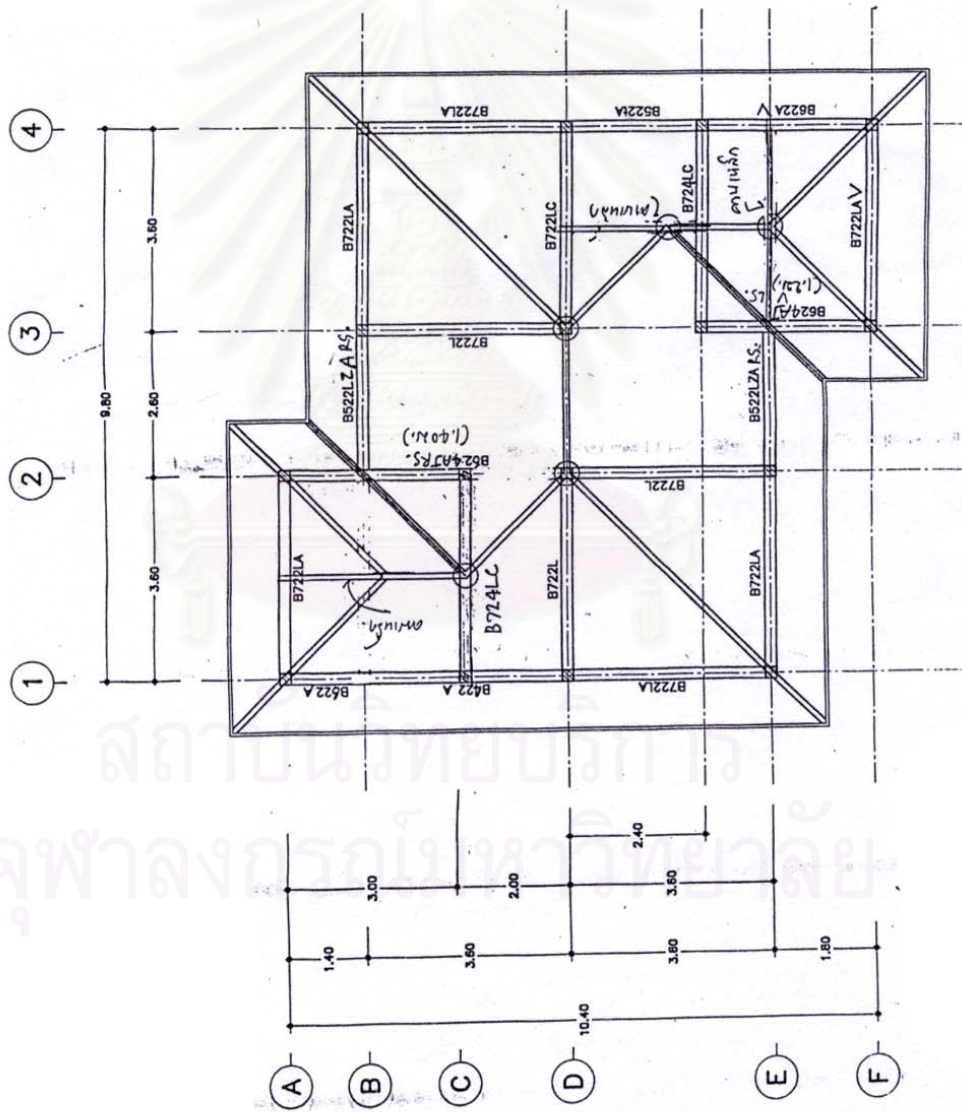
แสดงแบบ Part Drawing ของคานยื่น
